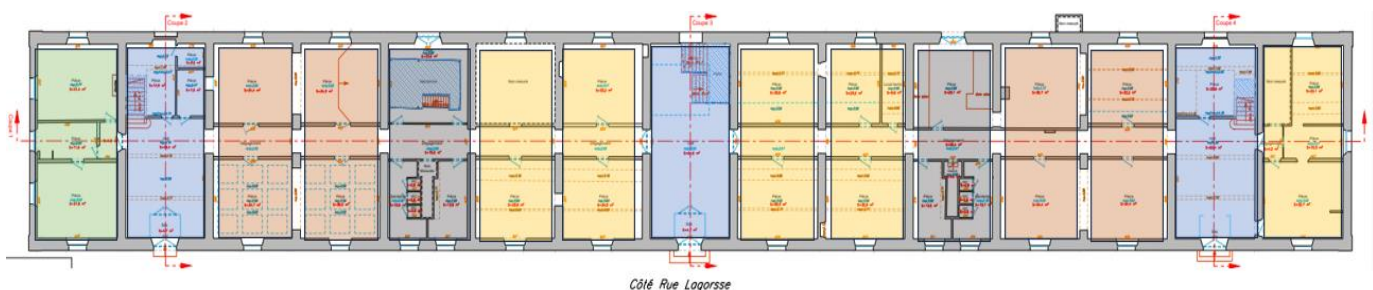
zonage selon les systèmes constructifs du plancher haut du RDC
